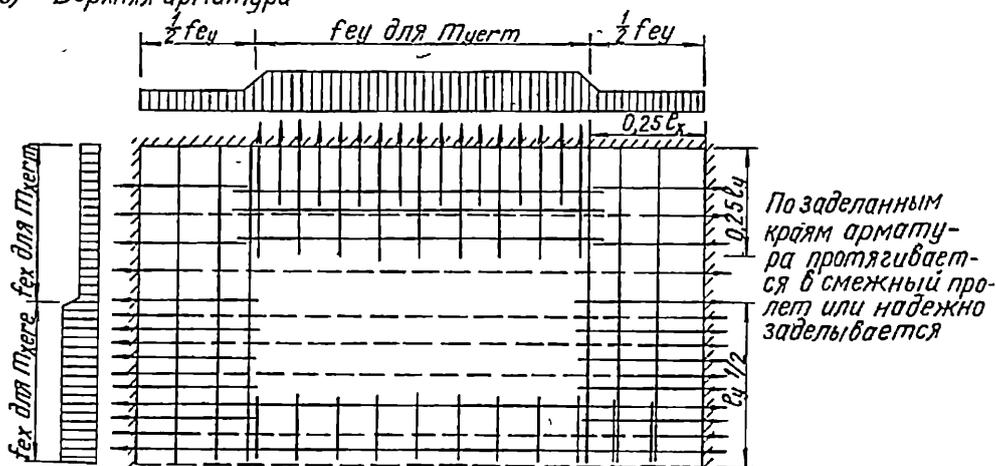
28. Армирование плит, полностью защемленных по трем сторонам, с одним свободным краем (для равномерно распределенной нагрузки)
